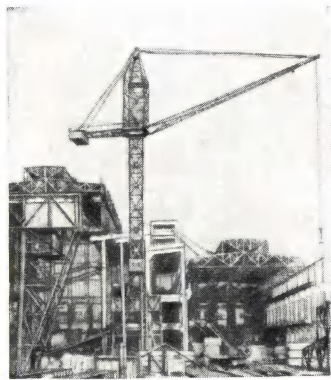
Монтаж сборных железобетонных конструкций здания ТЭЦ.
